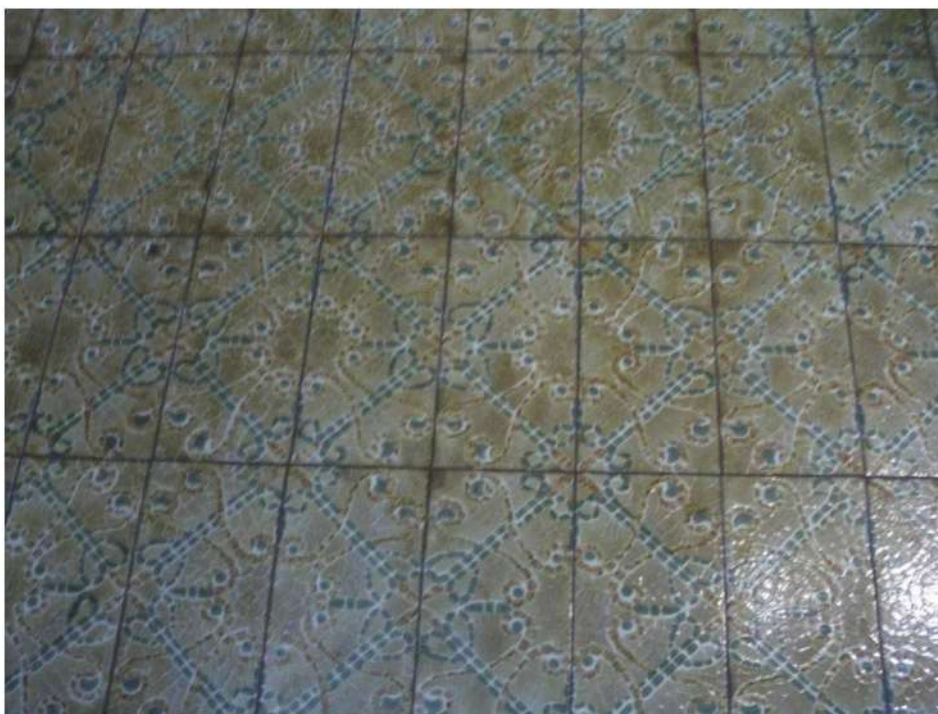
Foto interno : particolare pavimento – sub 3 piano 1°
